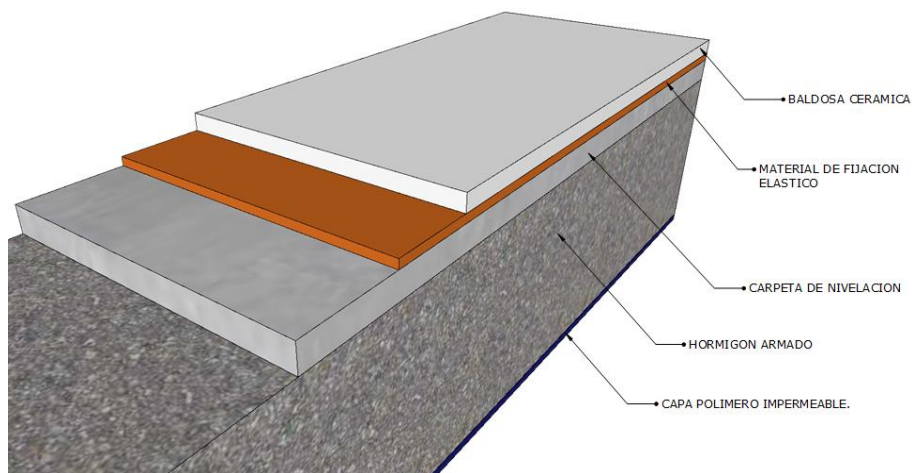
| Detalle de paquete de paño de hormigón armado
